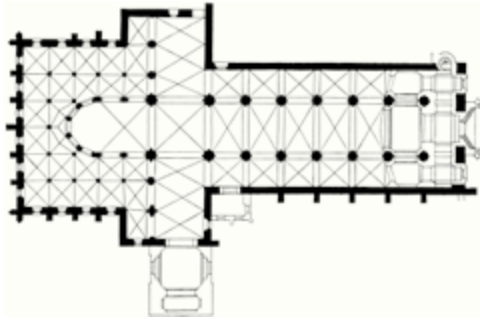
Grundriss der Stiftskirche Lilienfeld mit Hervorhebung der Bauteile des 13. Jahrhunderts
